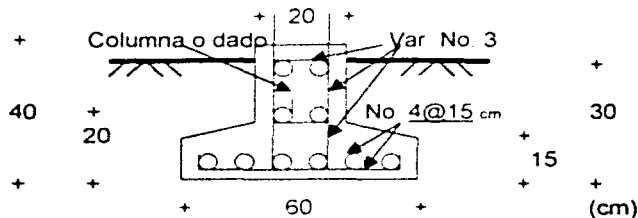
Zapata central de concreto por unidad de ancho. Recubrimiento de concreto $r = 3 \text{ cm}$
